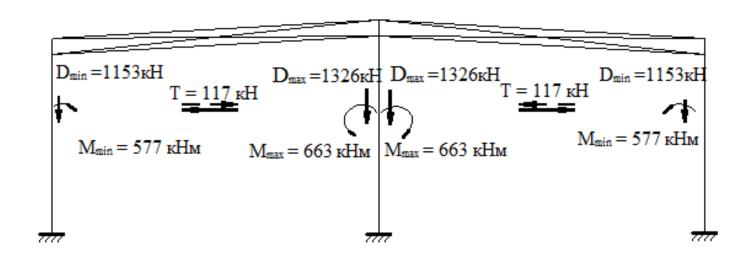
(б) Схема приложения крановых нагрузок №2 (максимальное загружение средней колонны): кран находится вблизи колонны Б пролета АБ, и вблизи колонны Б пролета БВ.
